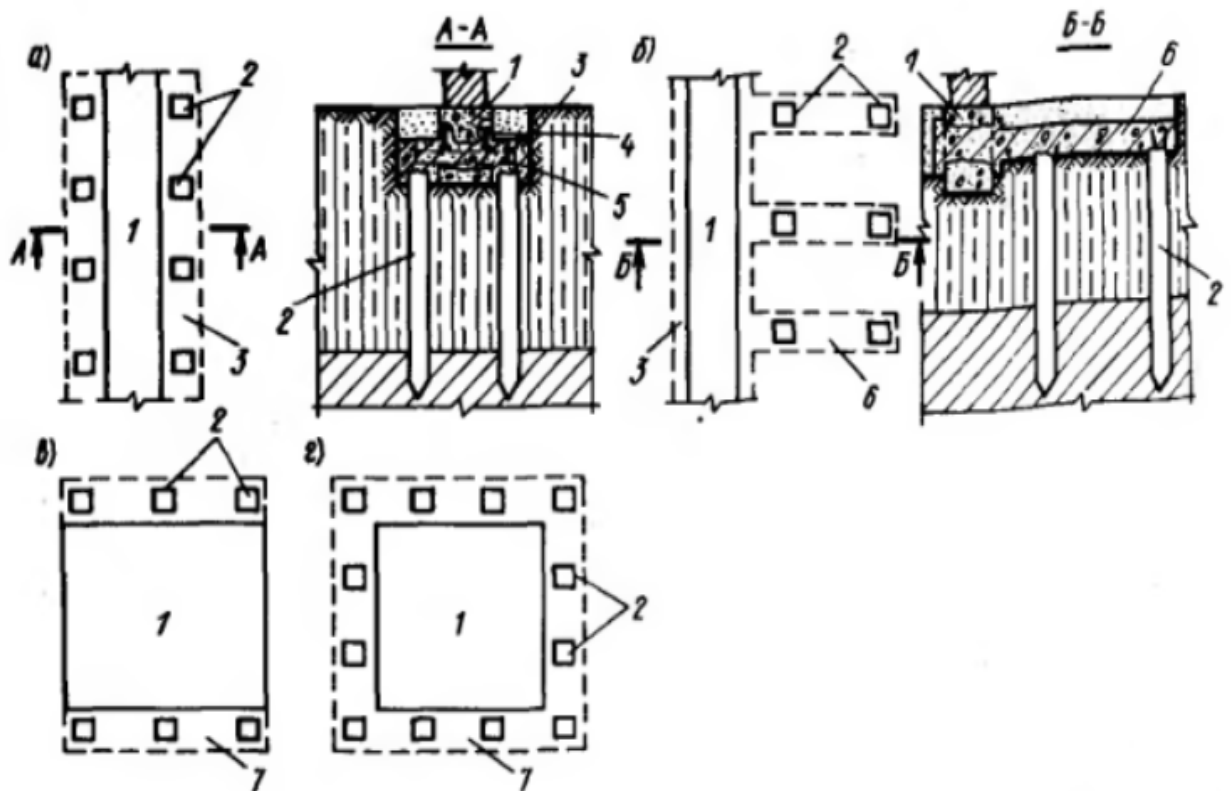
Схеми розміщення виносних паль при підсиленні стрічкових і стовпчастих фундаментів: 1 – фундамент, що підсилюється, 2 – паля, 3 – залізобетонний пояс, 4 – рандбалки, 5 – поперечна балка, 6 – важільний ростверк, 7 – залізобетонна обойма
